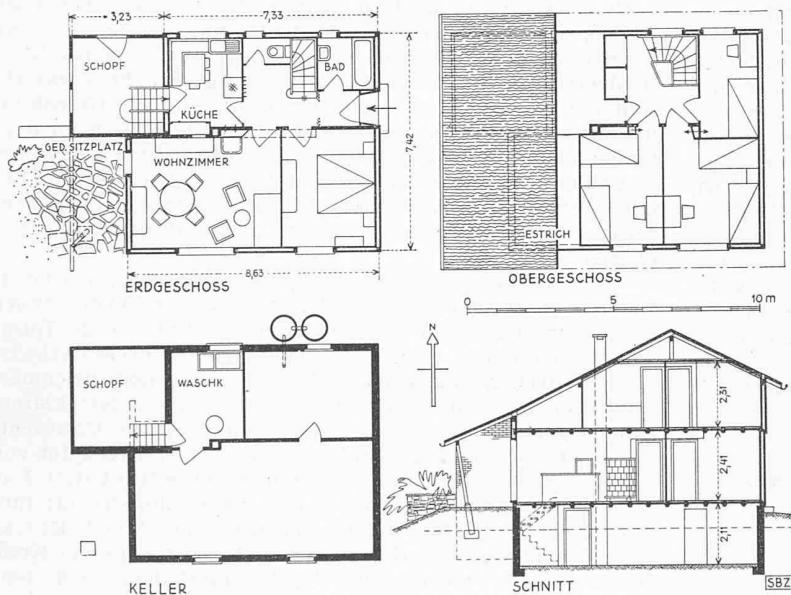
Grundrisse und Schnitt zu Bild 8, Masstab 1:250
